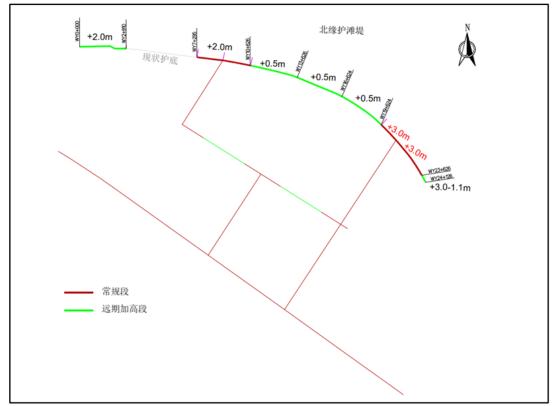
外缘护滩潜堤一期工程高程平面示意图
